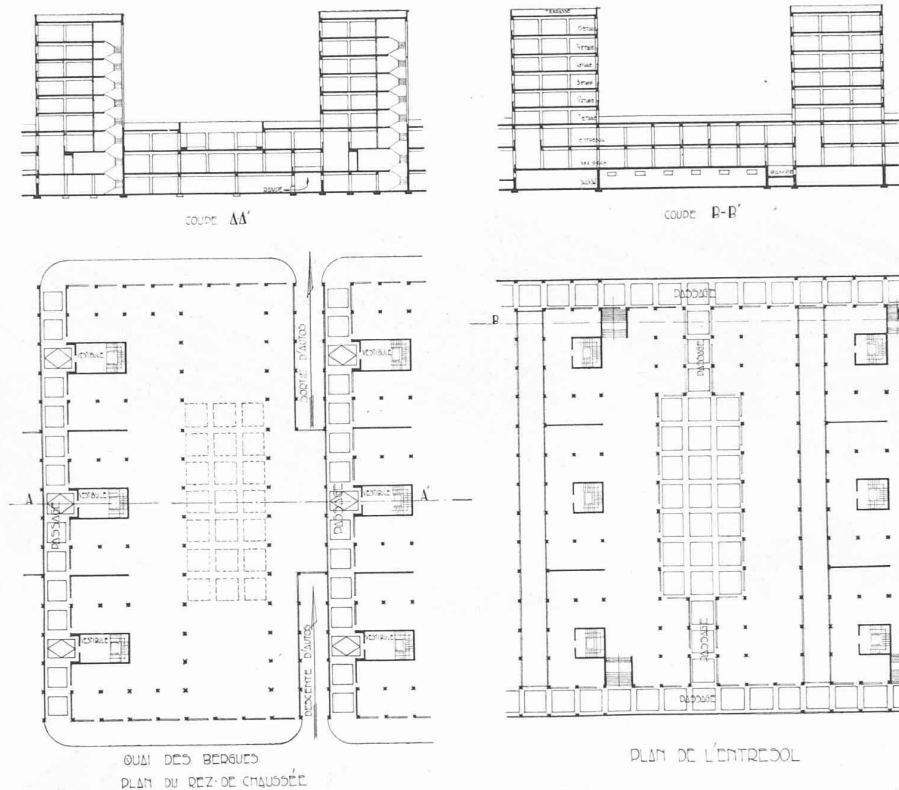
Plans du rez-de-chaussée et de l'entresol (trottoirs supérieurs et passages)
